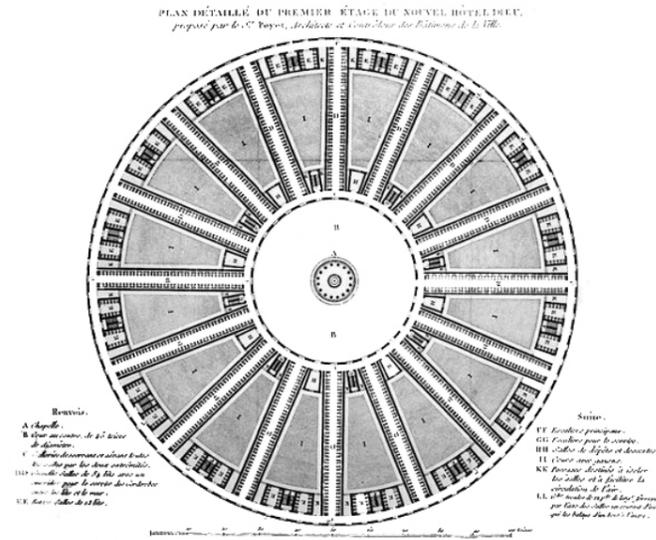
Grundriss Hôtel-Dieu, Paris, 1774
